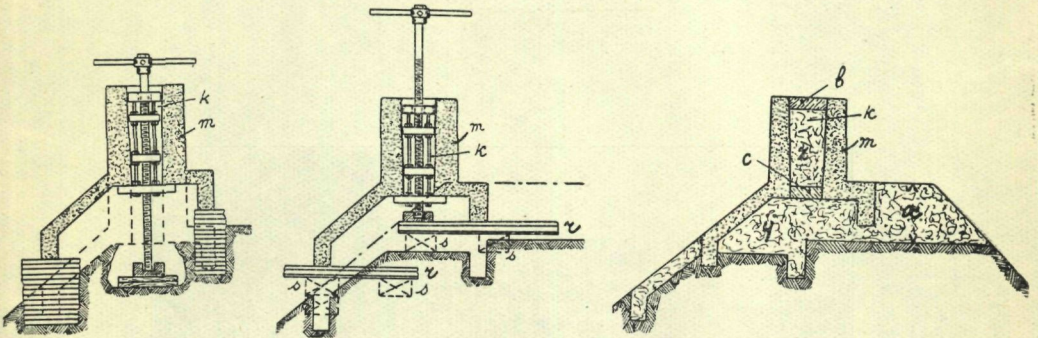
Rehaussement avec de la terre rapportée sous le parapet.
